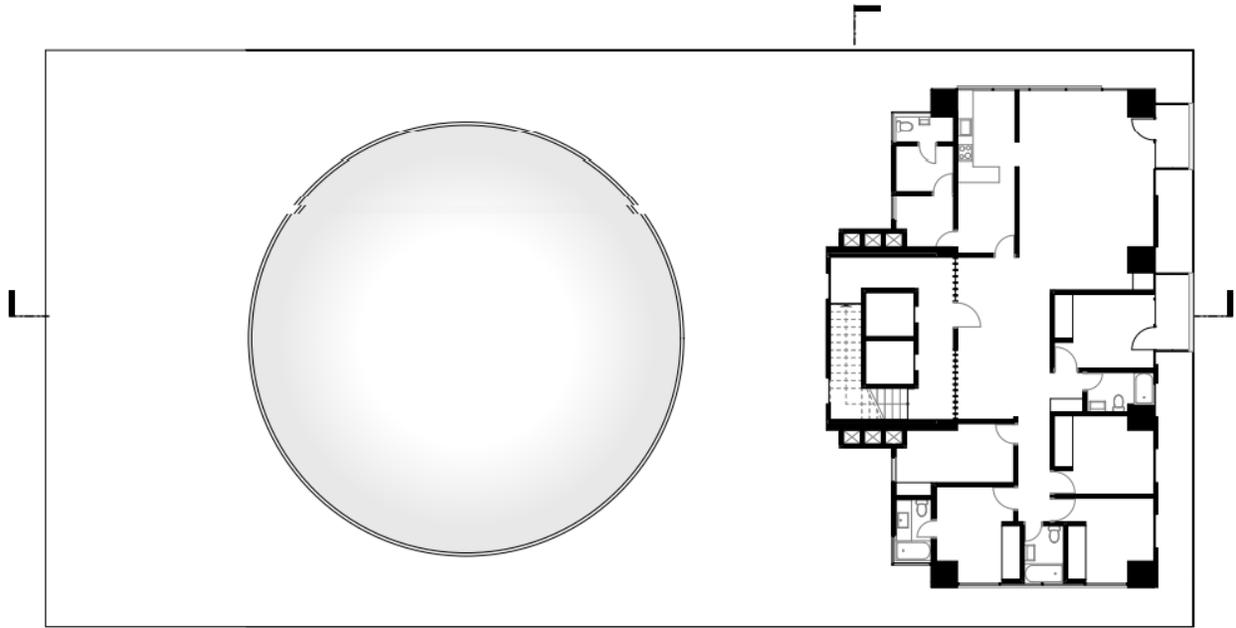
Planta alta actual N+15.50. Fuente: Tesistas.
